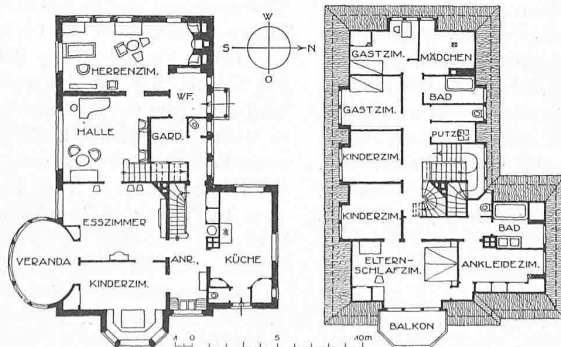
u. 18. Haus Bouncken. — Grundrisse 1:400.
